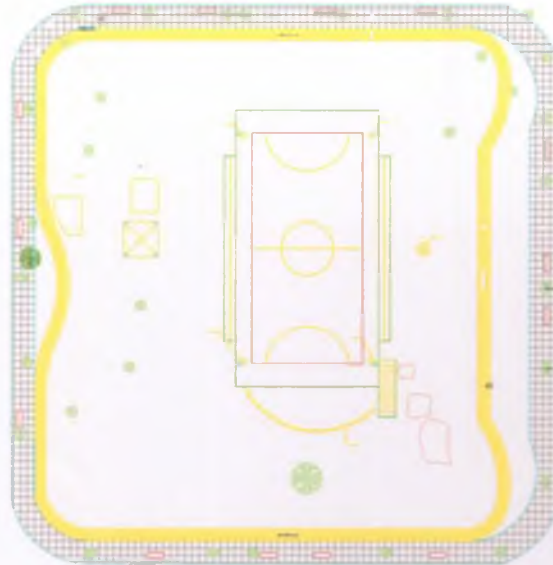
Planta baixa da praça Jardim Novo Horizonte.
